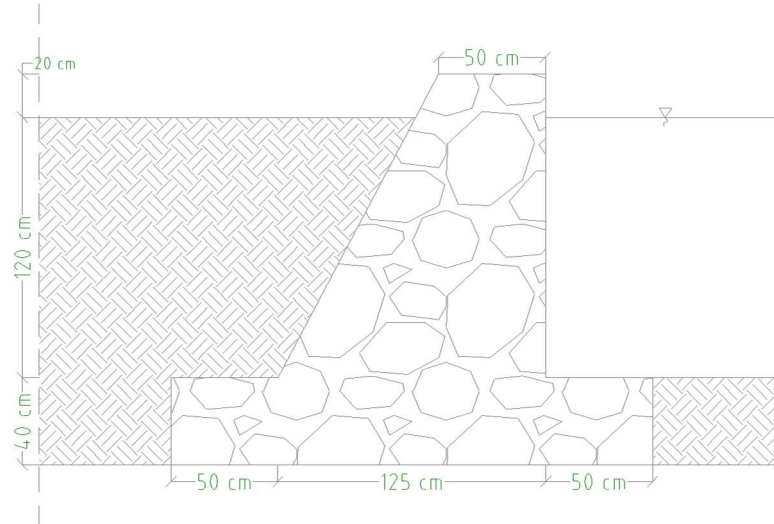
Detail Dinding Penahan Tanah (Potongan A-A)
